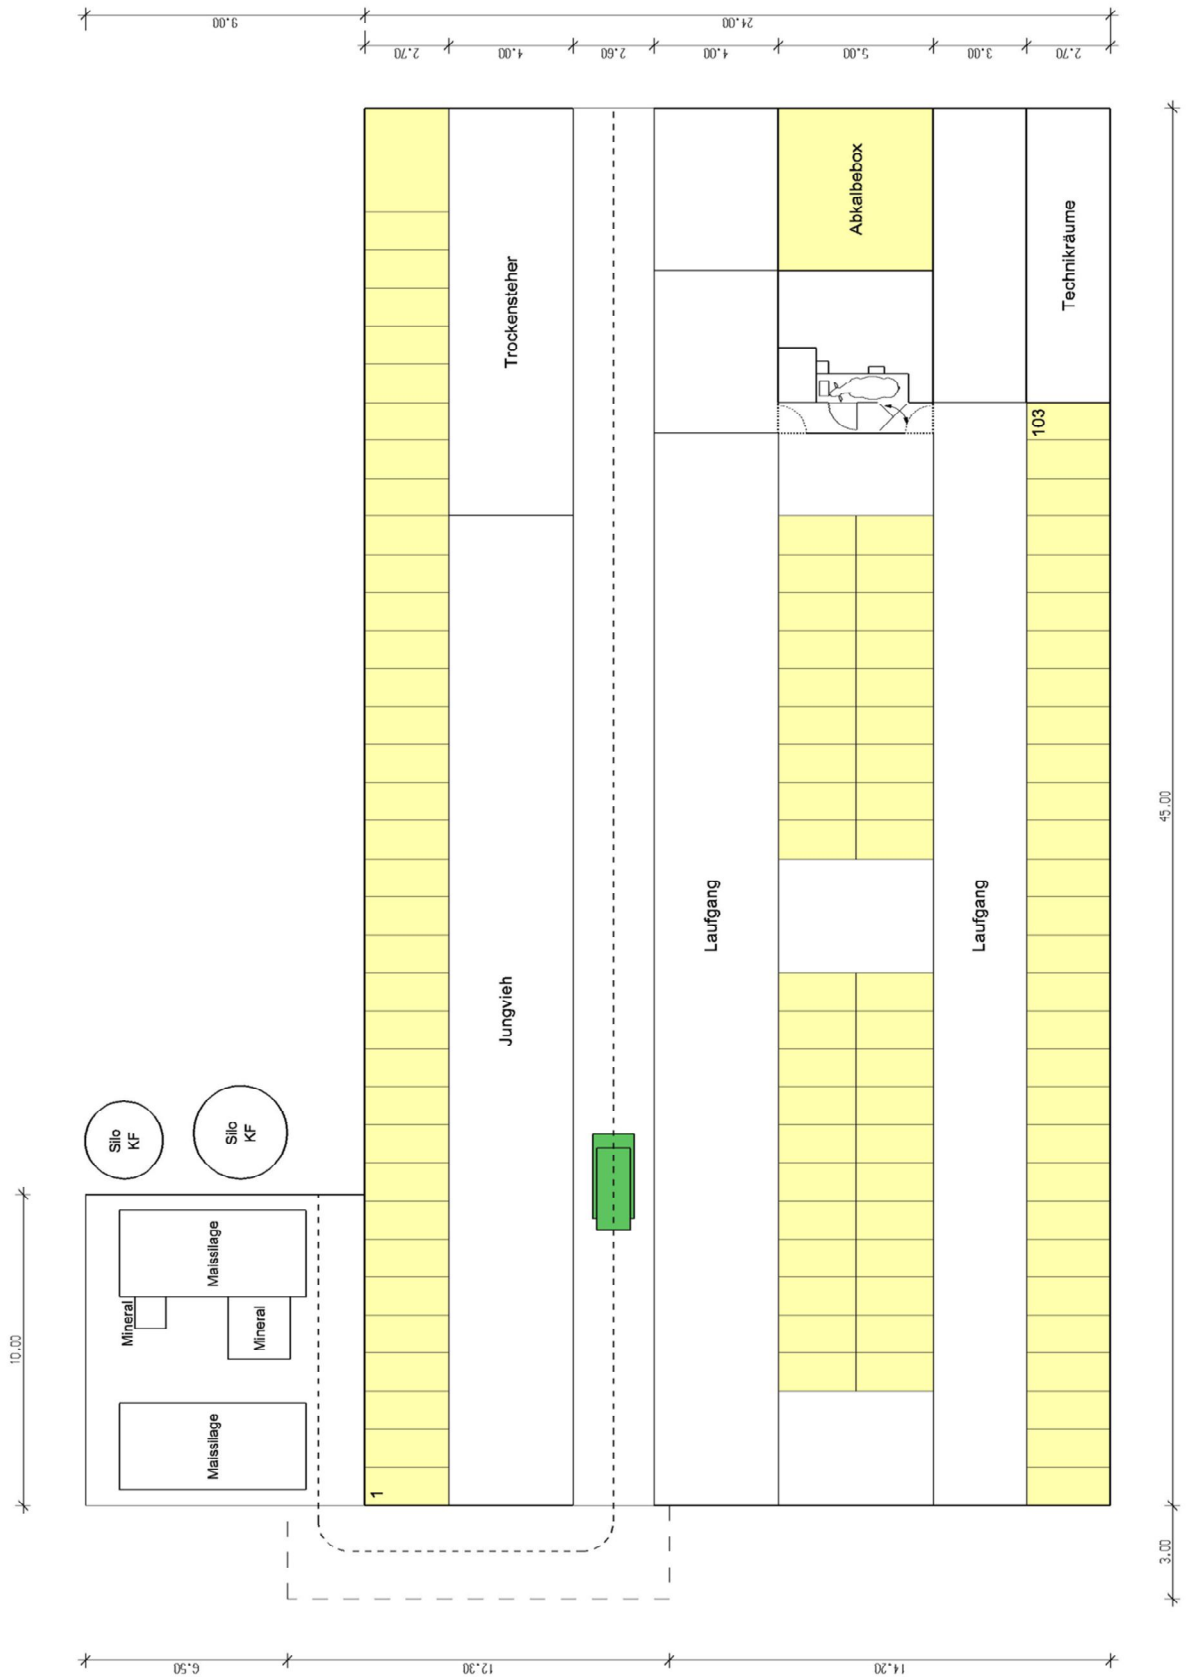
Stallgrundriss Betrieb 5 (KF: Krafffutter)
